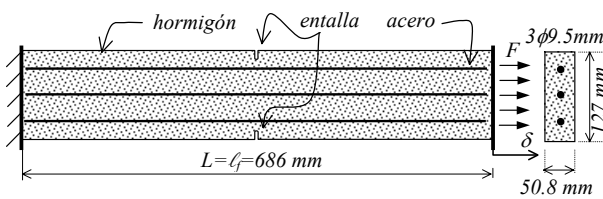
Esquema descriptivo del ensayo de tracción con refuerzo distribuido.
